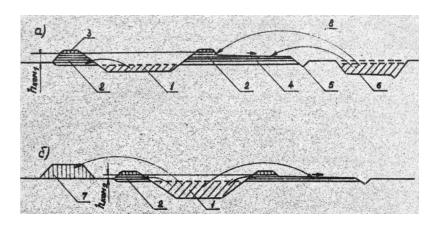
Строительство канала при большой Са) и малой (б) высоте командования:
